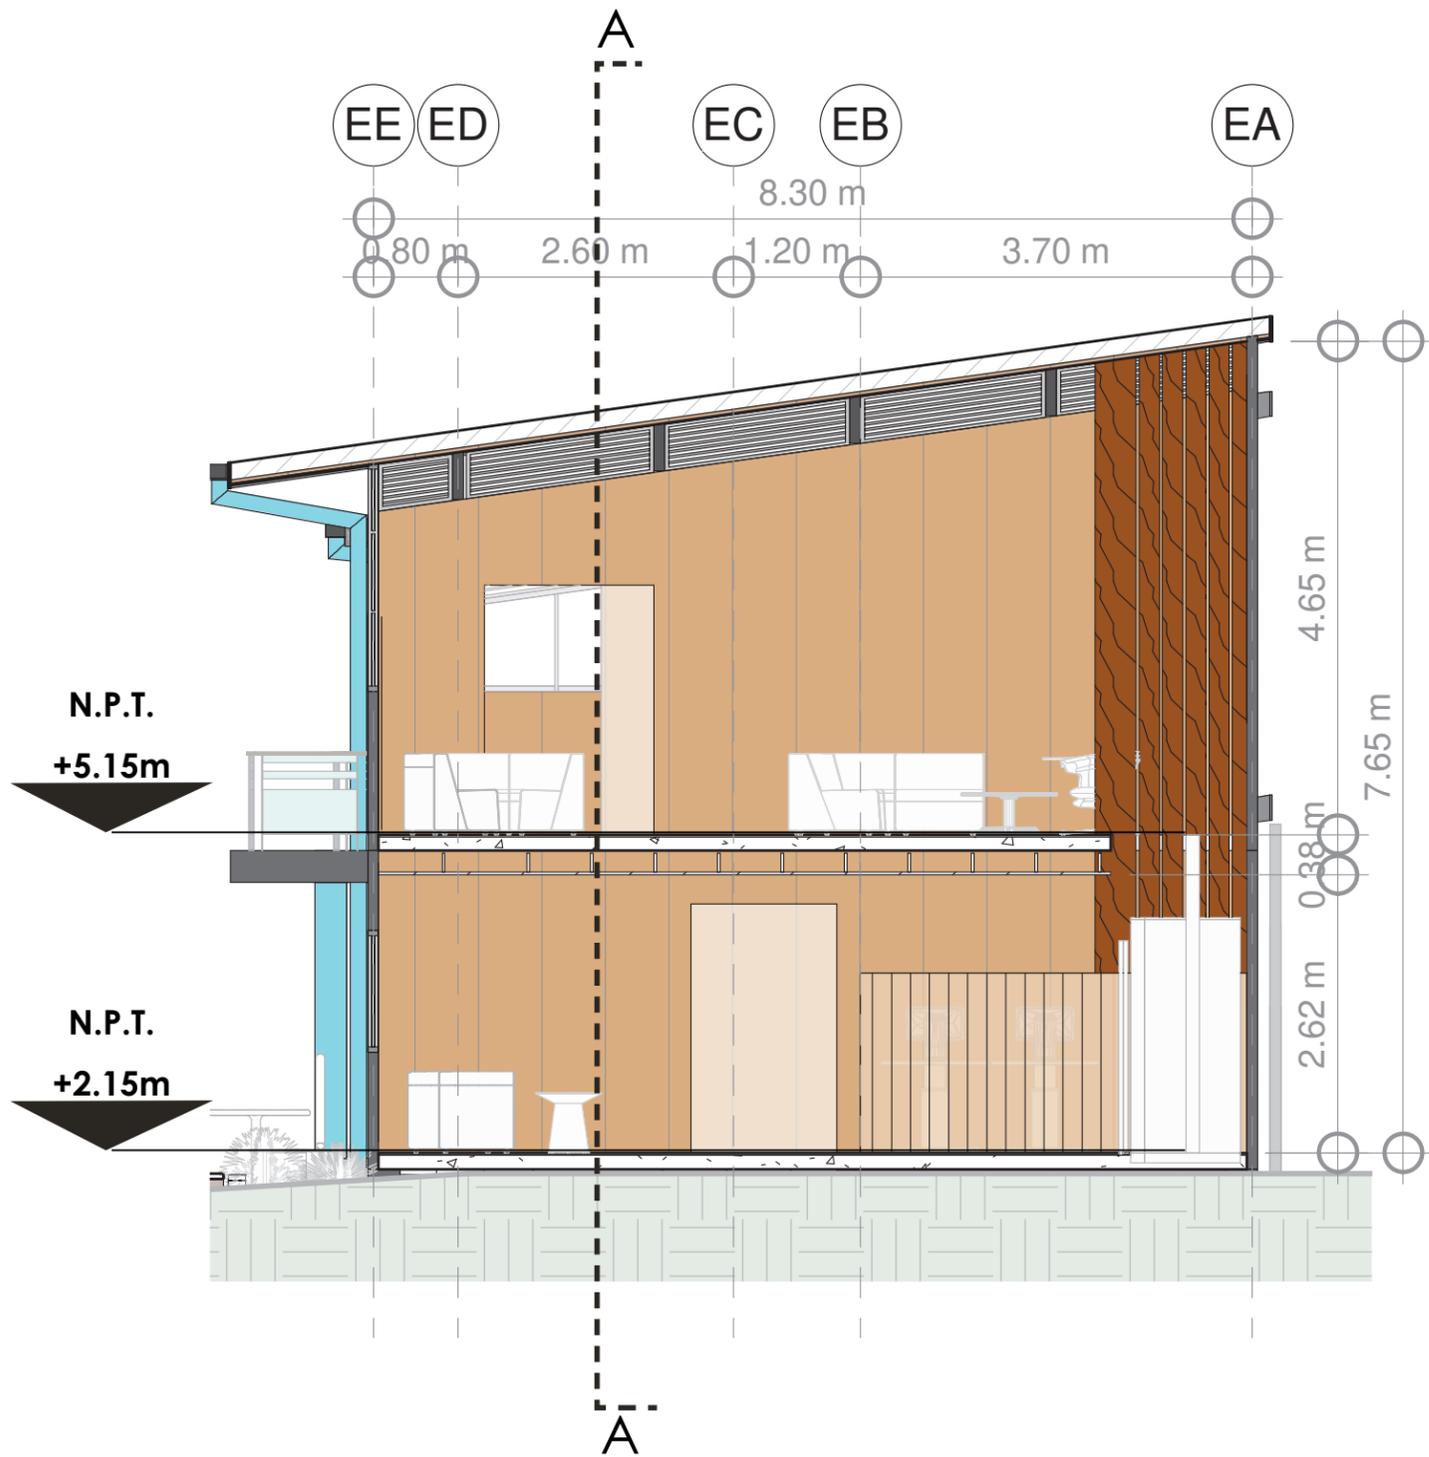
Sección B-B de bloque educativo. Fuente: Propia.
